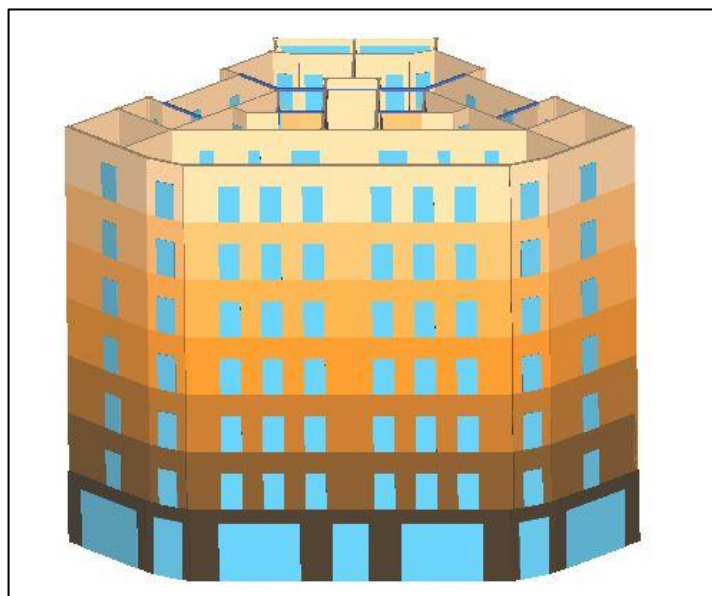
Edificio modelado con Tremuri (Fuente: Propia)
